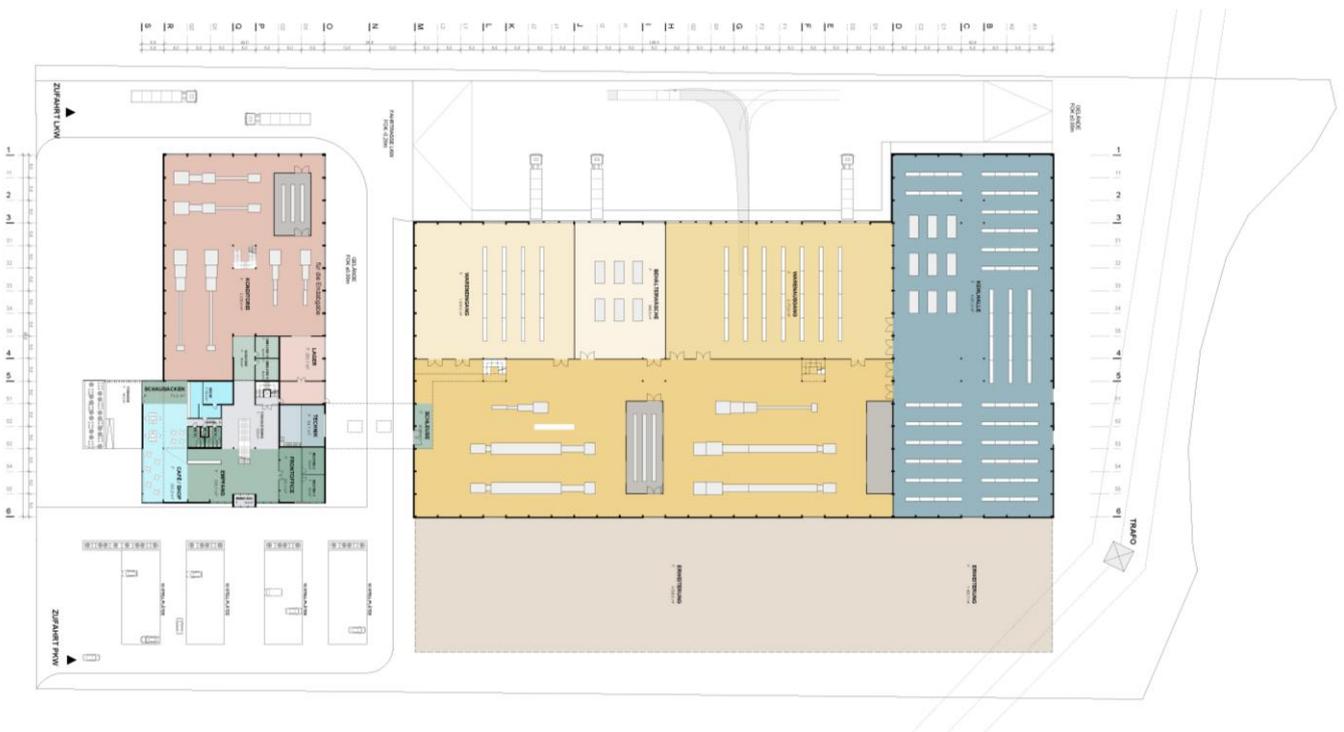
Grundriss Entwurf Alpen Backwerk
